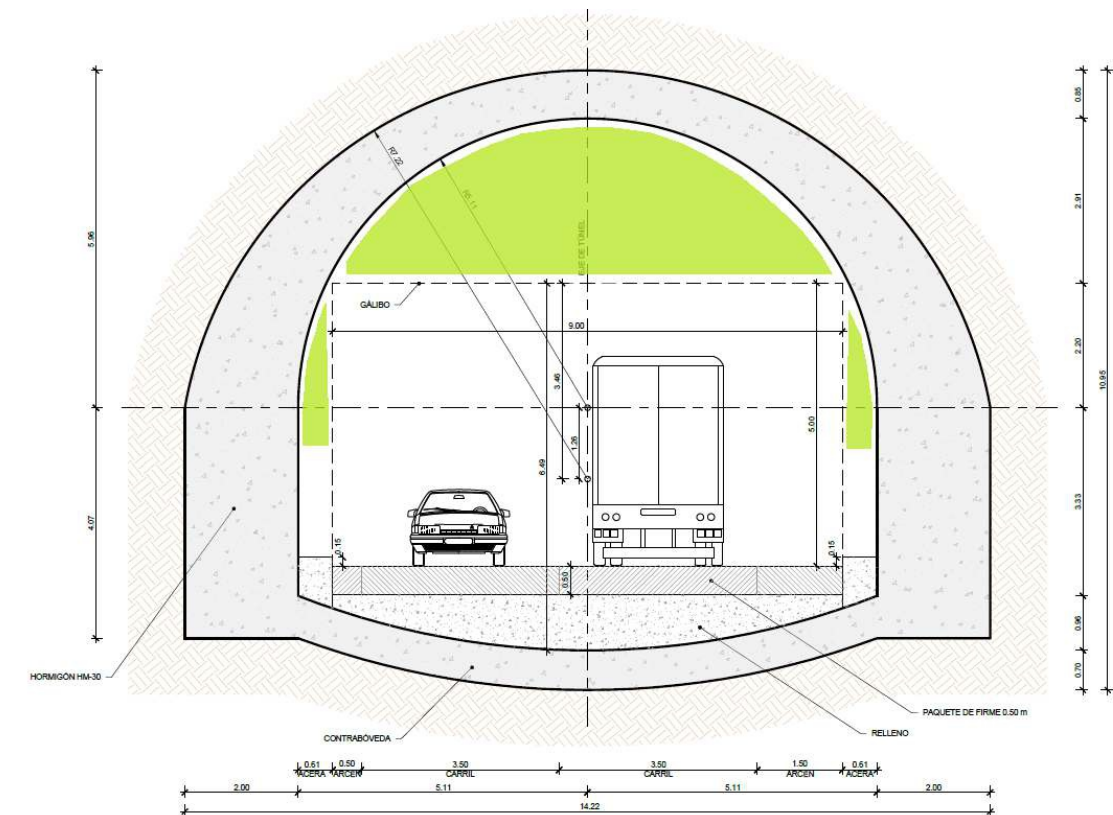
Sección útil del túnel en mina, con zonas en verde disponibles para la instalación de equipos.
